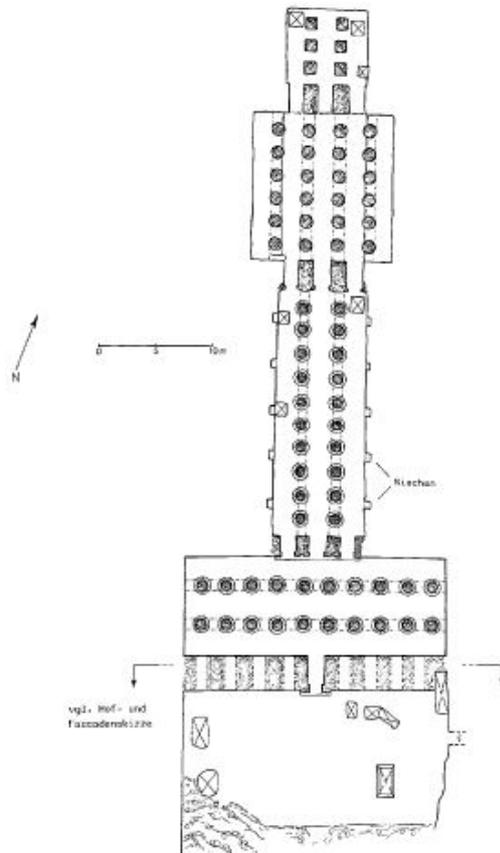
Pianta TT192. Fonte Epigraphic Survey 1980 plate 3
